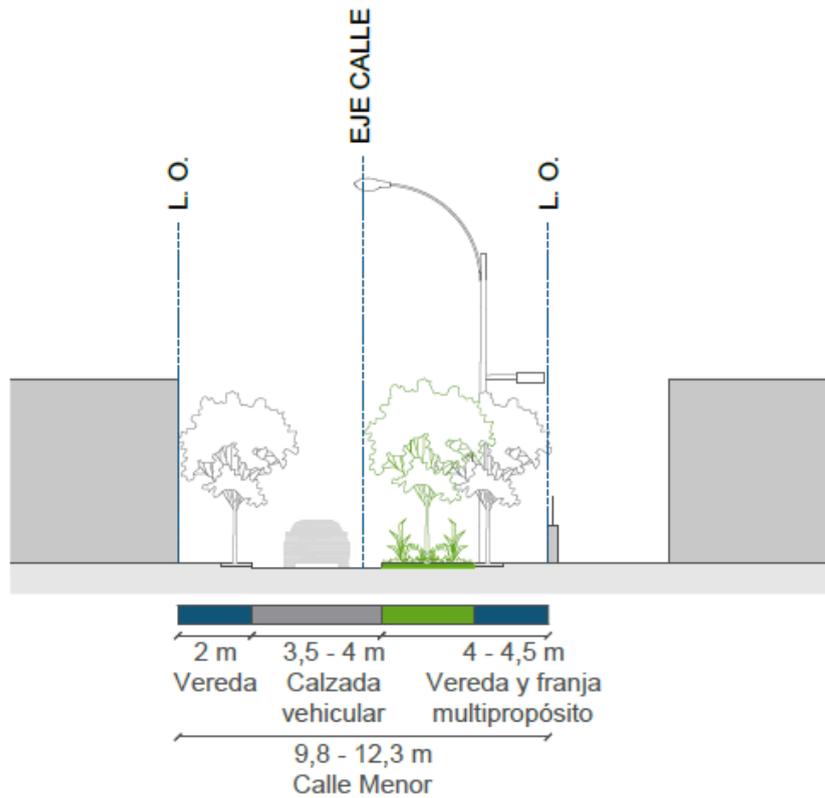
Perfil tipo. Situación propuesta Calles Menores.
